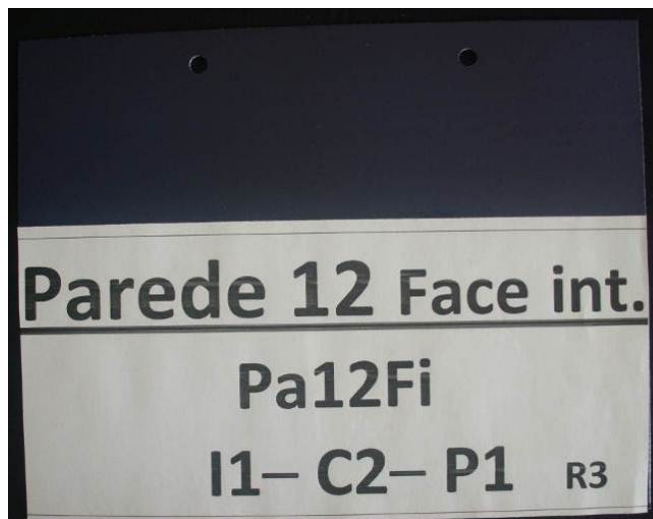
Identificação da parede 12. Face interna, impermeabilização tipo 1 (flexível), contrapiso tipo 2 (abaixo da viga baldrame), pintura tipo 1 (3 dias) após a aplicação do revestimento. Revestimento aplicado no 3º dia
